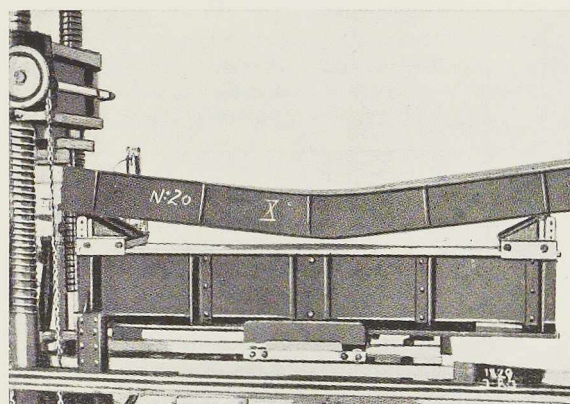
Essai d'une poutrelle munie de 5 raidisseurs.
